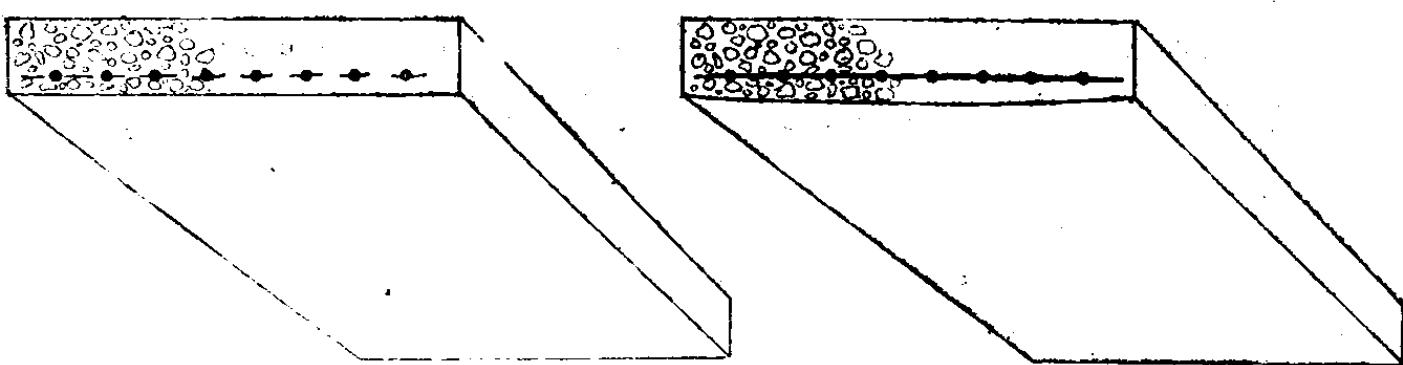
5 裂缝也会在混凝土的厚度范围从一根钢筋伸向另一根钢筋。混凝土内部的空洞虽然看不见，而如果用锤子敲击保护层，就能很清楚地听见空洞声
